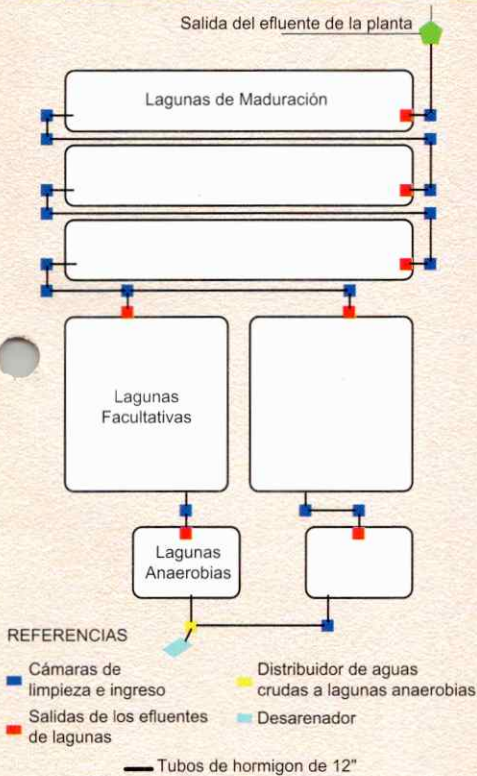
Disposición de las lagunas e infraestructura en la planta de tratamiento
